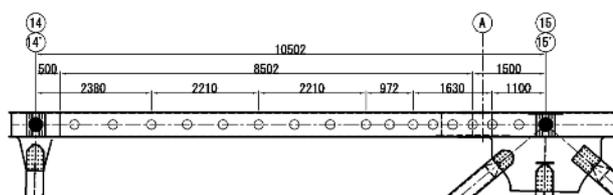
補剛桁上弦材の部材分割(格点⑭~⑮)
